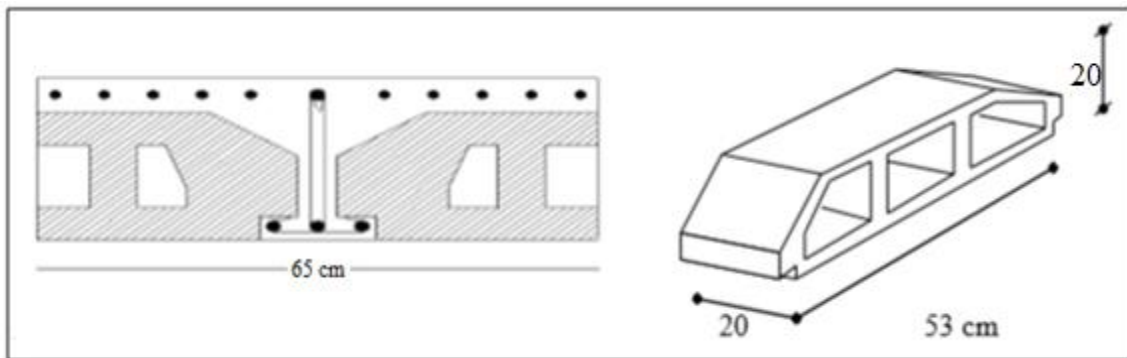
Coupe du planché en corps creux et dimension de corps creux
